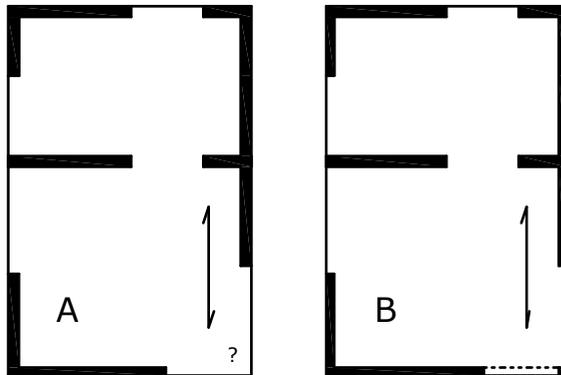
Disposizione in pianta dei solai. Nel caso A il solaio non trova appoggio nel punto "?"; nel caso B c'è un pilastro ed una trave, il solaio trova appoggio.
